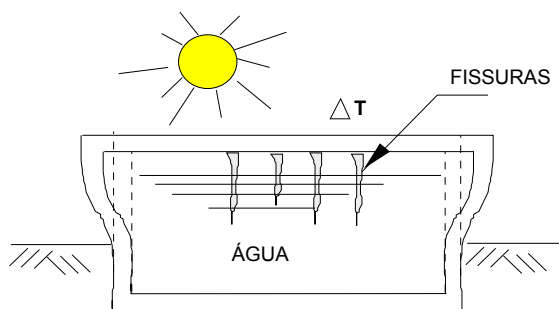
Exemplo de fissuração causado por alteração térmica externa
